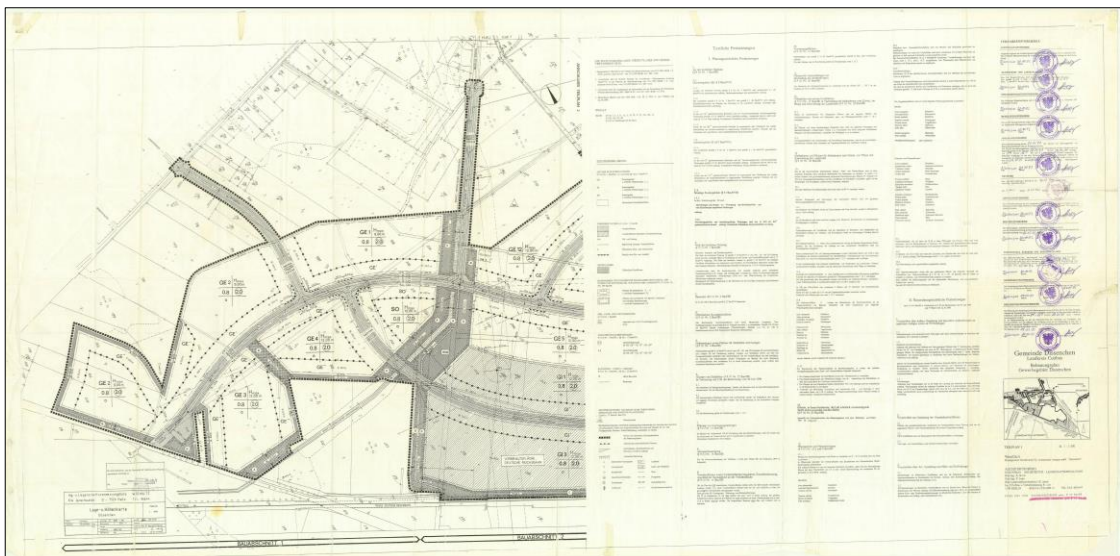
Bebauungsplan Gewerbegebiet Dissenchen Süd II, Urkunde, Teilplan 1
